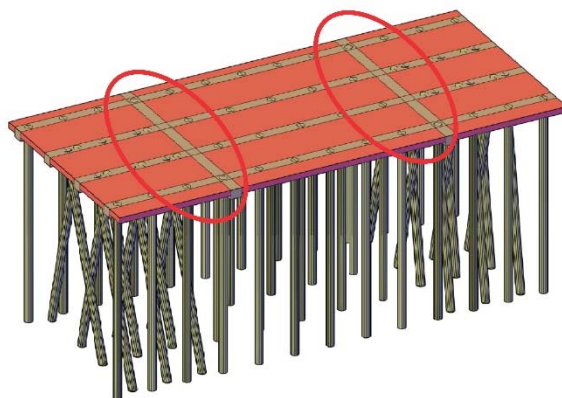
Vigas transversais adicionadas ao modelo tridimensional.
